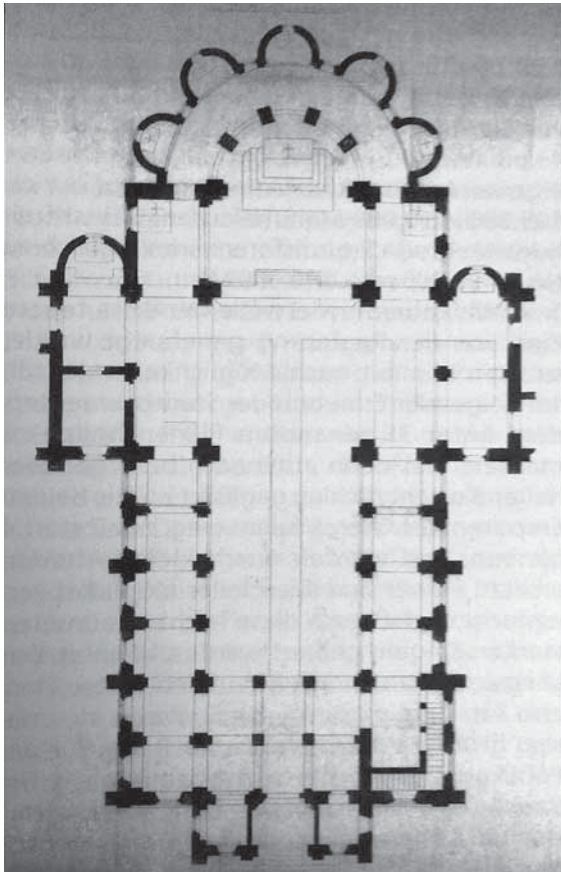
Grundriss Kirche Königin der Engel aus dem Jahr 1910
